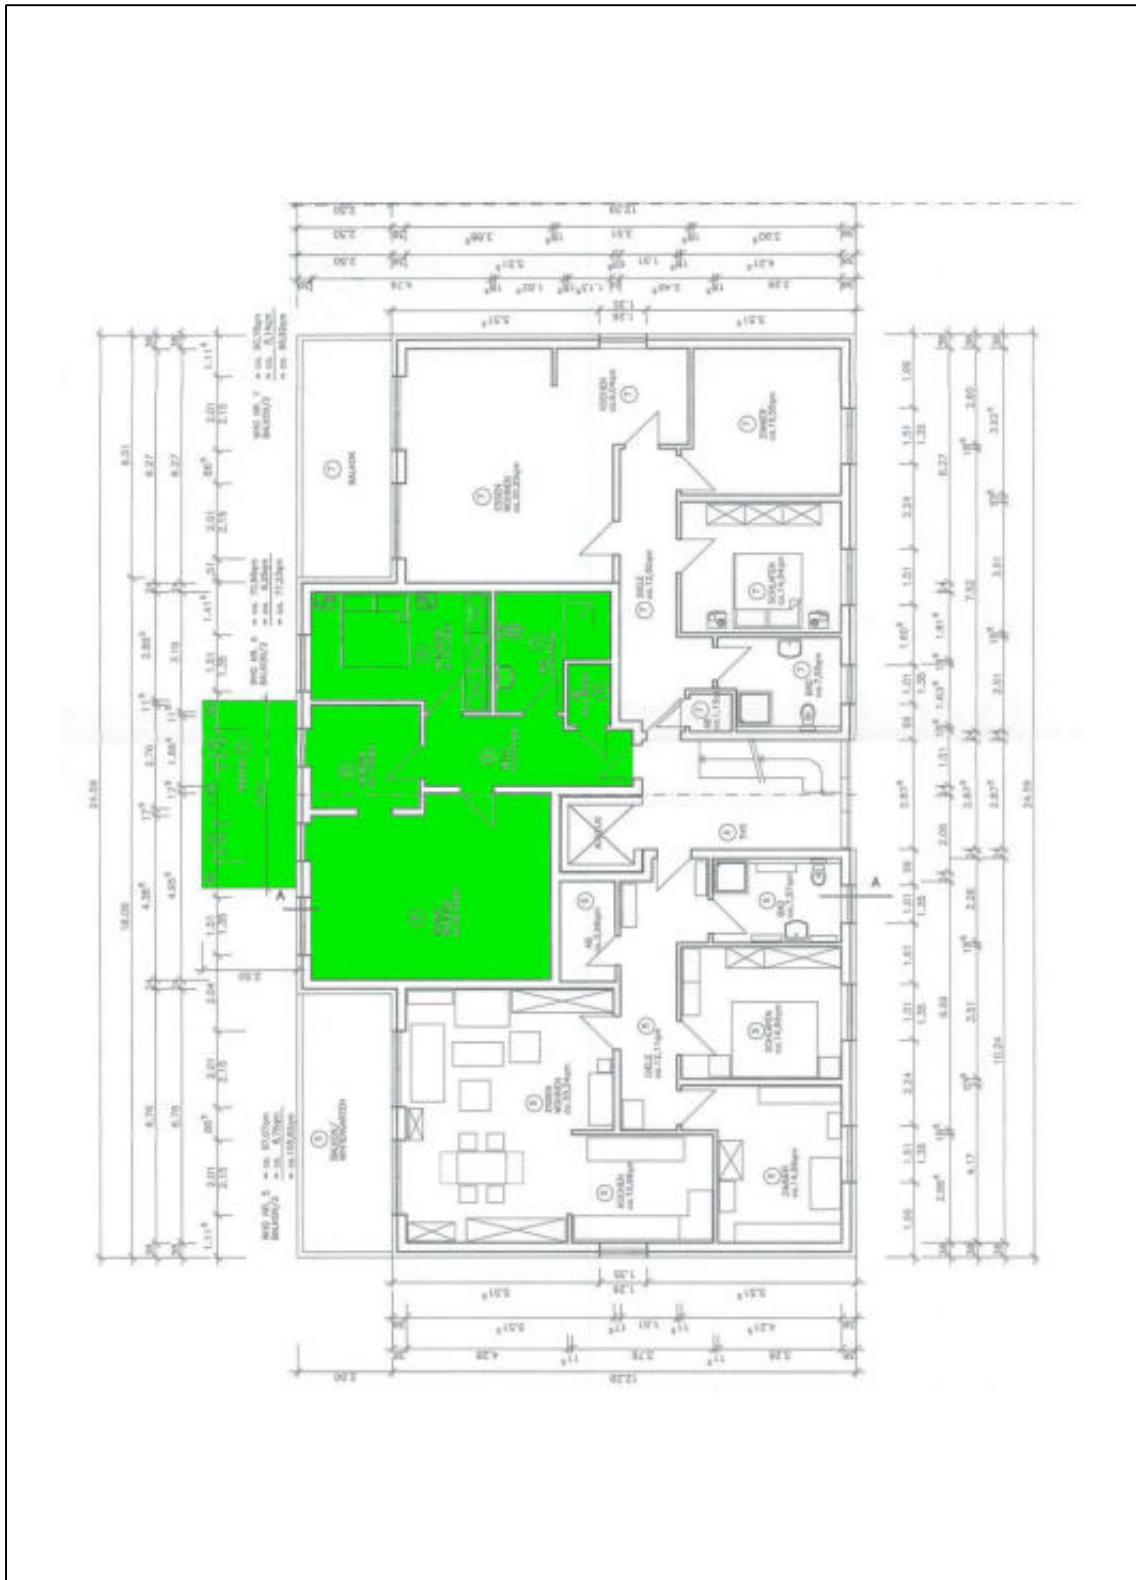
Grundriss vom 1. Obergeschoss
